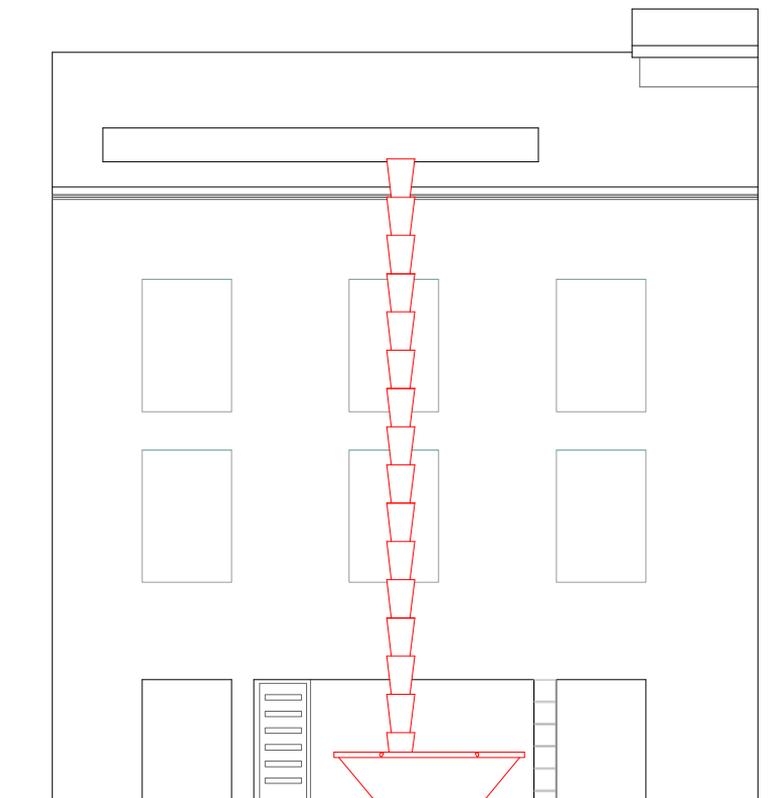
Ubicación en fachada de contenedor de 5 m³ y tubo de descarga.
